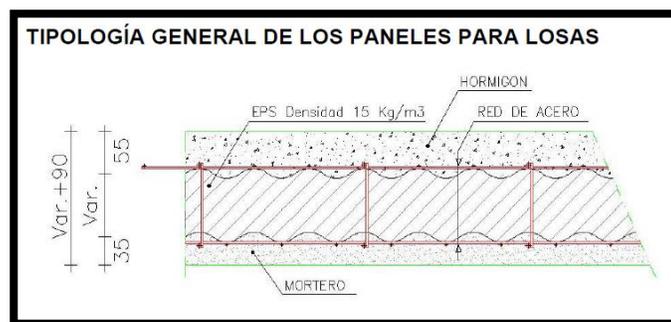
Tipología General de los Paneles M2 para la elaboración de losas
